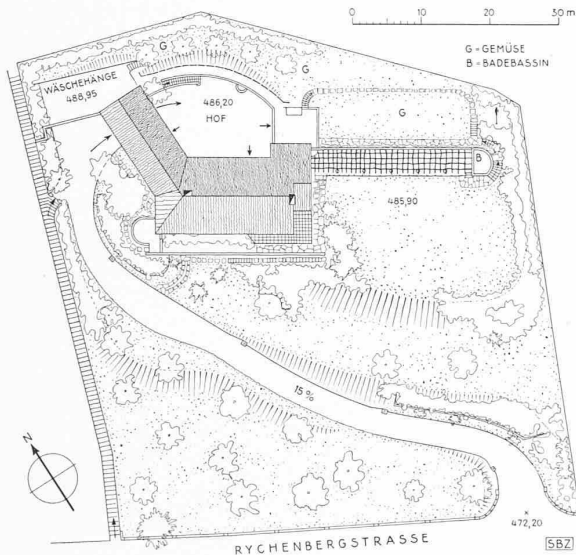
Wohnhaus P. B.-R. in Winterthur. — Lageplan 1:1000
